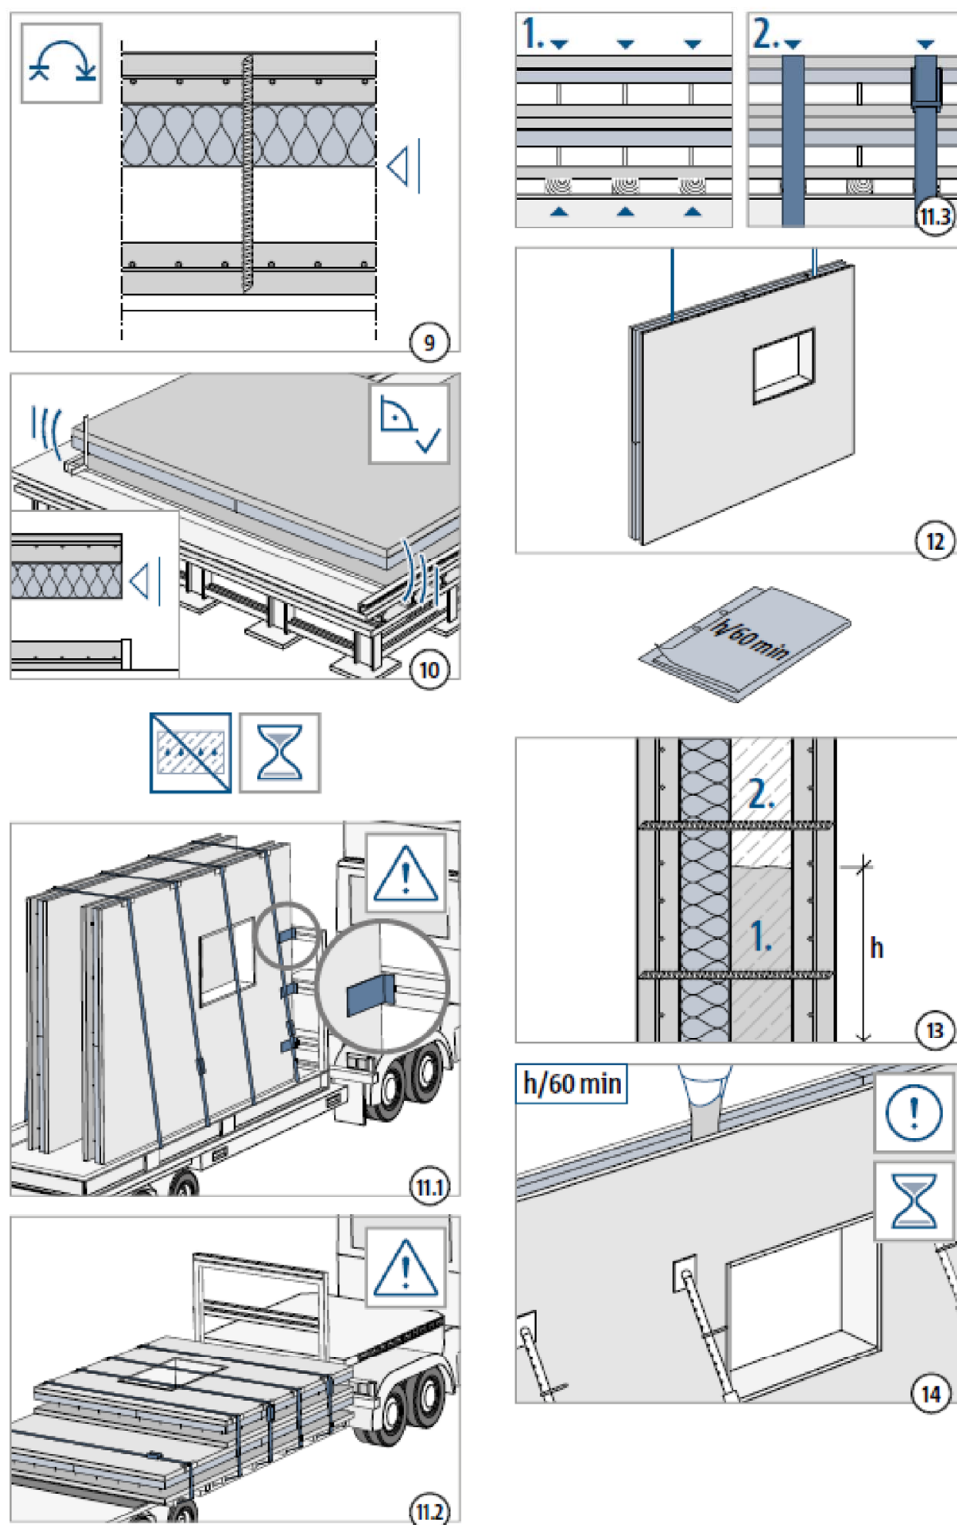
Montageanleitung - Schöck Isolink® für Elementwände – Seite 2
